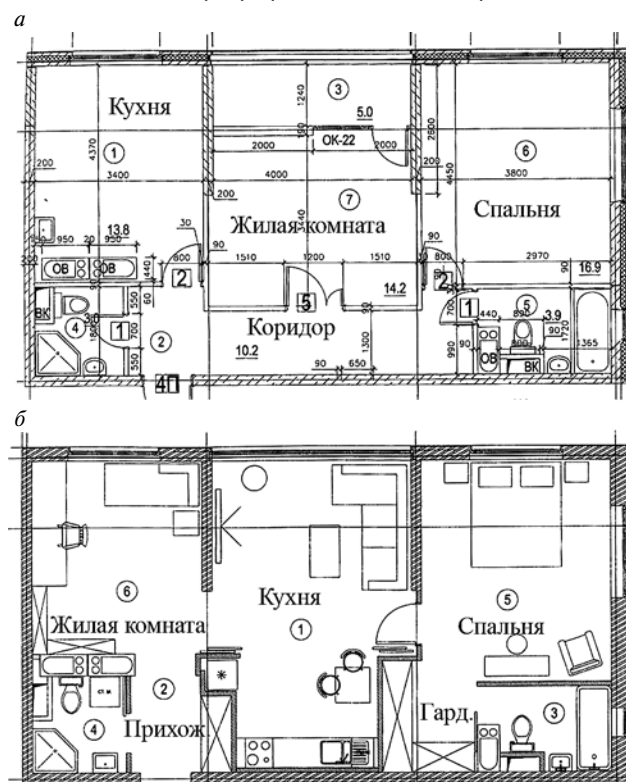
Проект перепланировки двухкомнатной квартиры: а – план квартиры до перепланировки; б – план квартиры после перепланировки. Перенесена рабочая зона кухни, за счет этого увеличена жилая площадь квартиры
